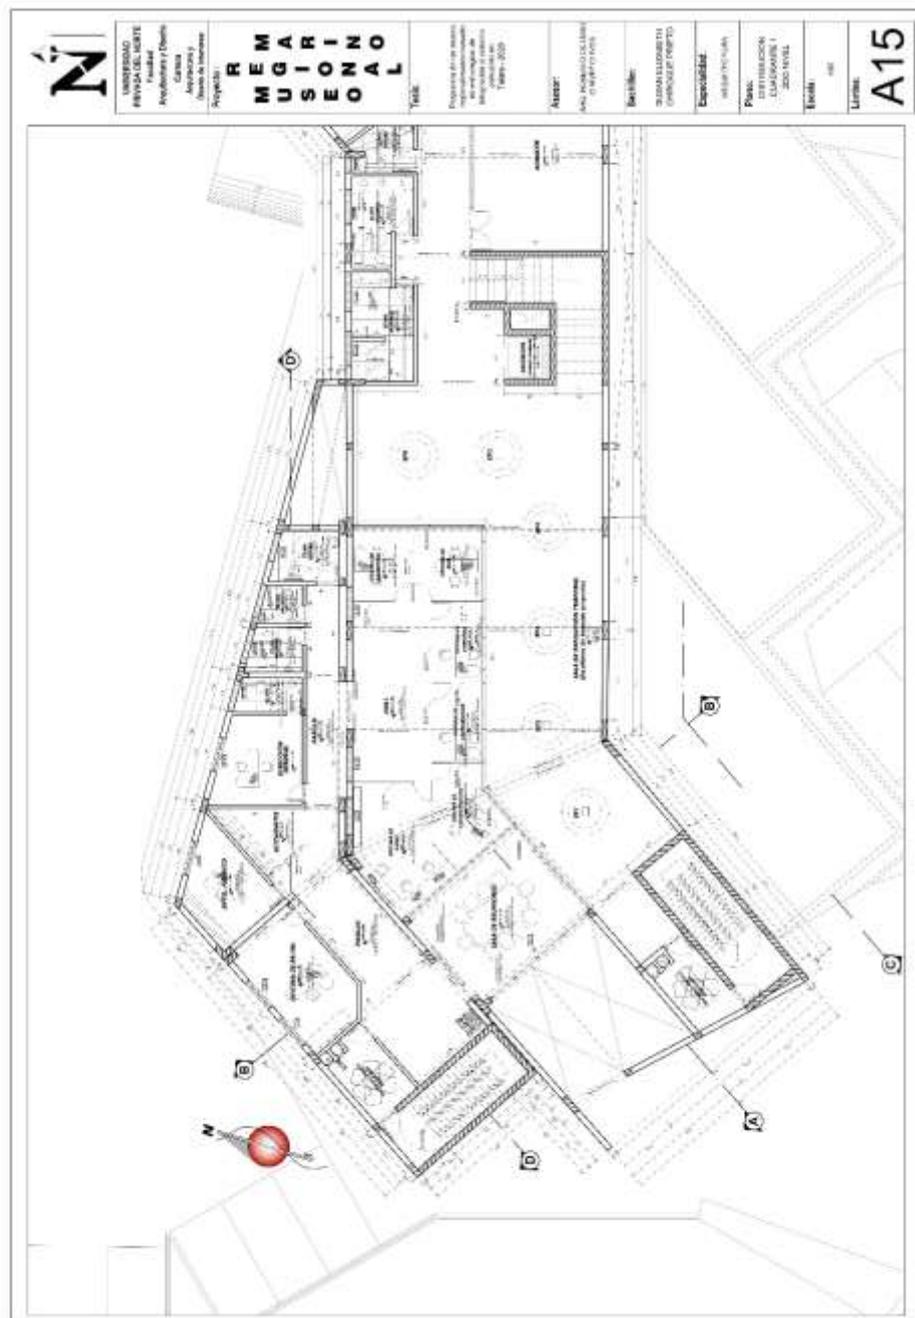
Distribución a detalle sector segundo nivel primer cuadrante.
